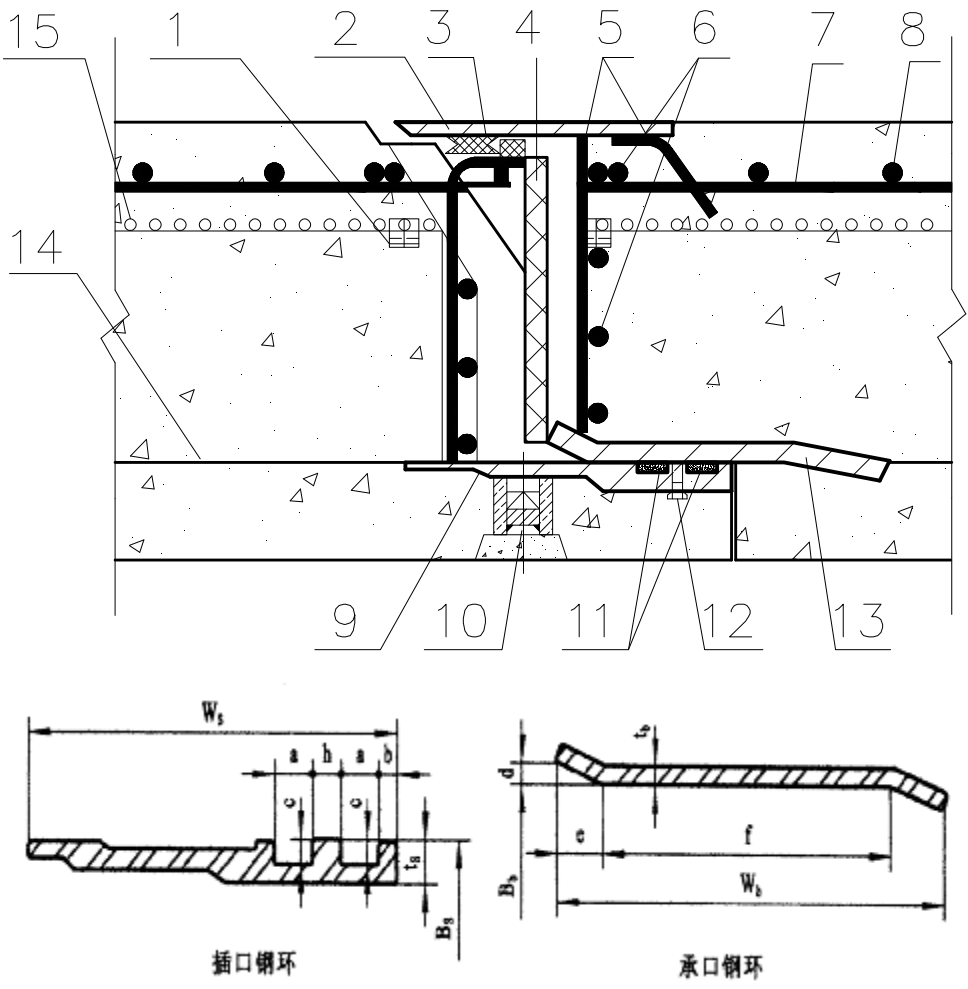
预应力钢筒混凝土顶管接头示意图
